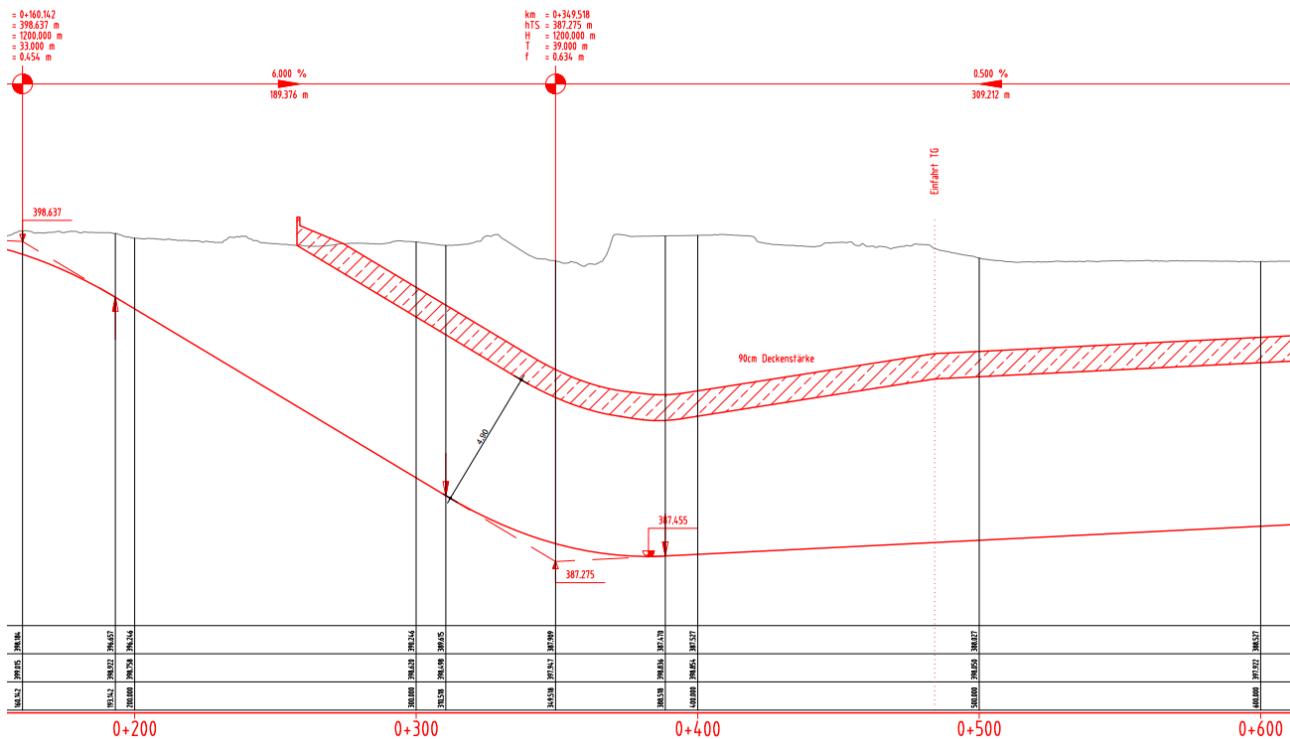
Längenschnitt im Bereich Portal West - Rampenneigung 6%.
